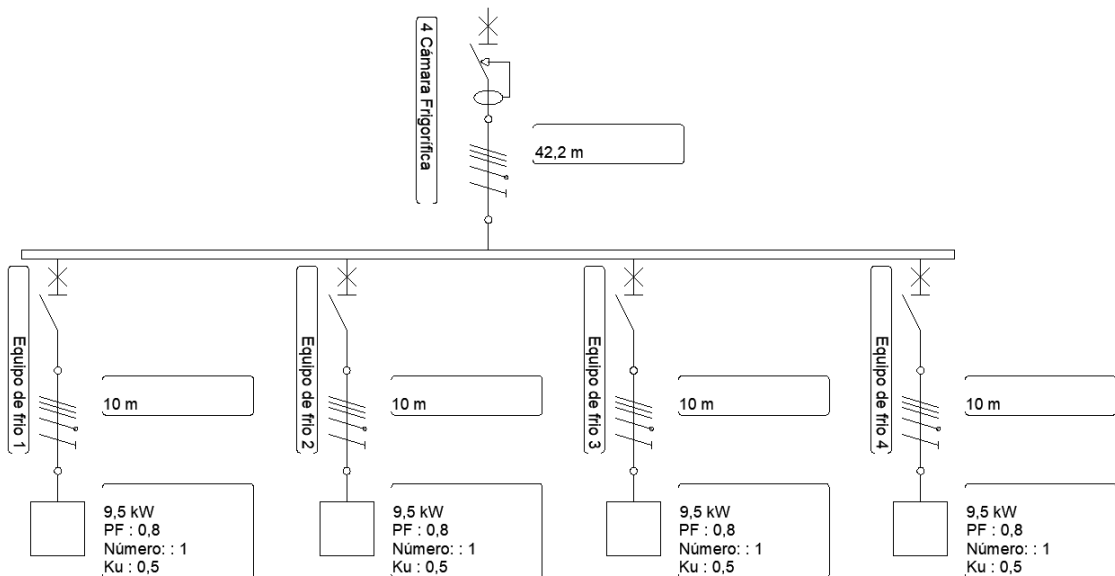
Unifilar Tablero Seccional 4 Cámara Frigorífica
